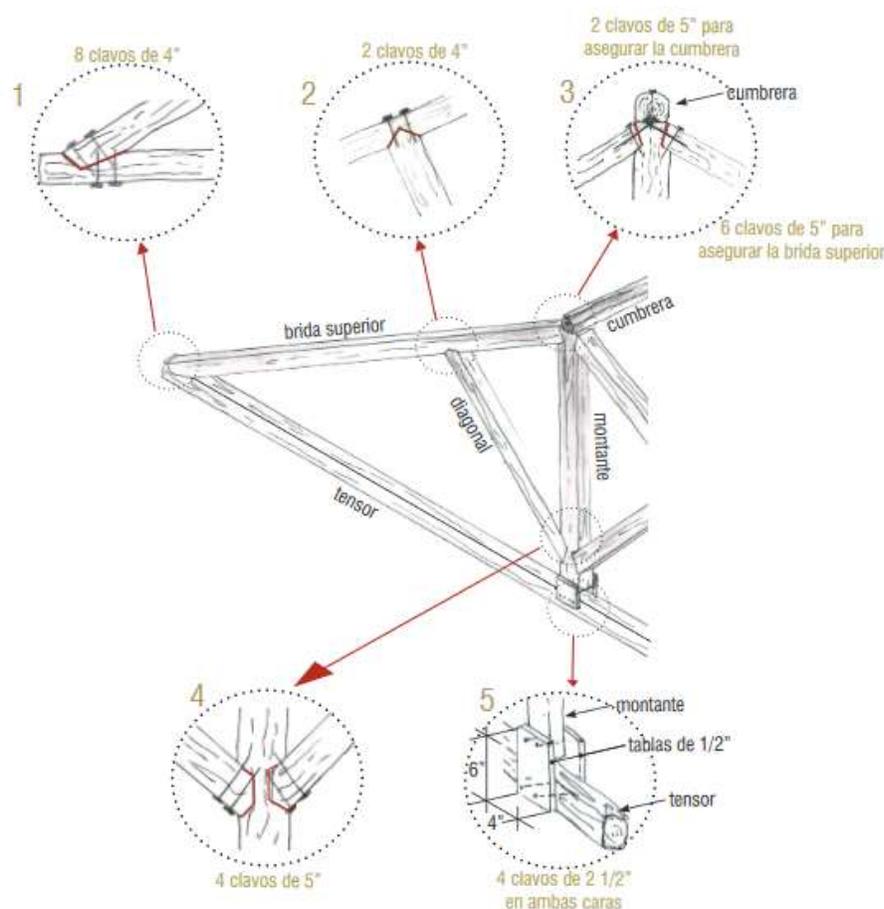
Estructura de techumbre. Fuente: MVCS, 2014.
